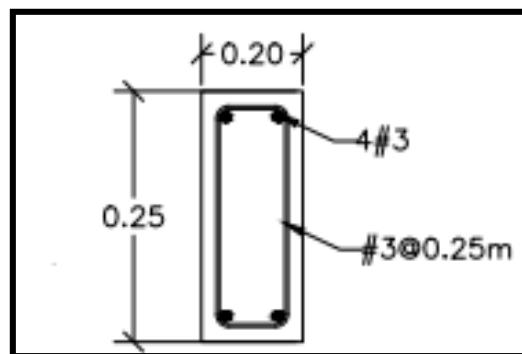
Sección transversal viga riostra Fuente: Tomado de Cartilla de Obras menores de drenaje y estructuras viales del Instituto Nacional de Vías.
